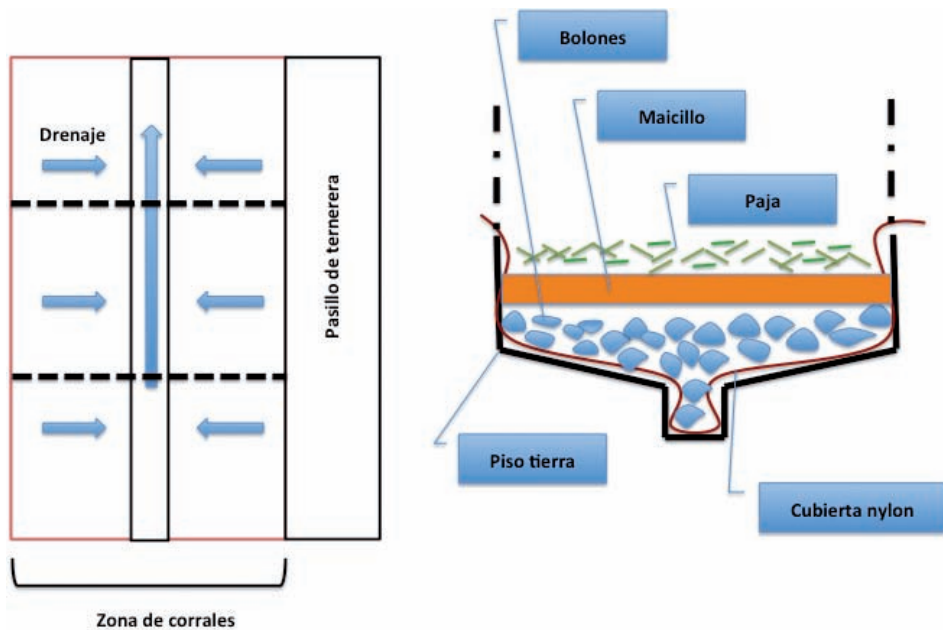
Esquema de drenaje de corrales de ternera. Vista superior y vista vertical.
